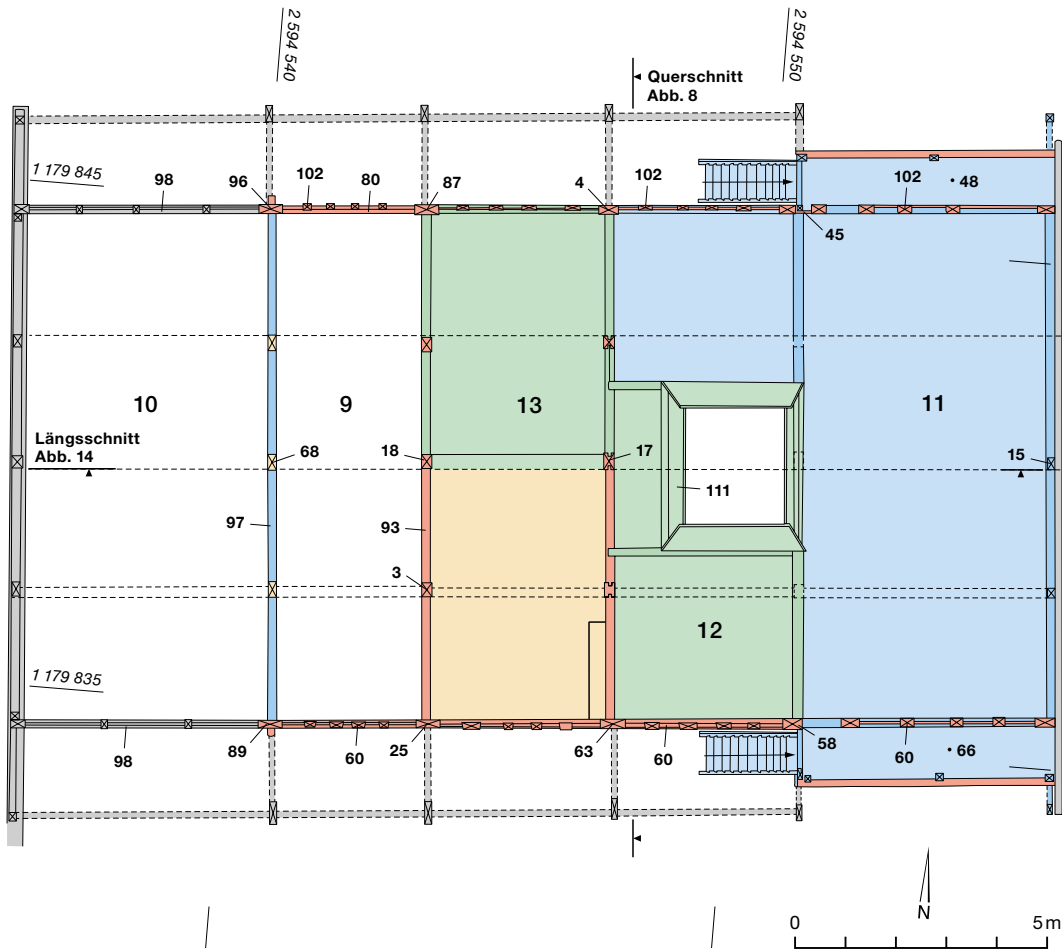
Rüschegg Sangern 183. Grundriss des Dachgeschosses. Die im 19. Jahrhundert durchgeführten Umbauten im Erdgeschoss schlugen sich über dem Wohntrakt in unterschiedlichen Fussbodenhöhen nieder. Im Unterschied zum prinzipiell offenen Tenn (Raum 9) verlor der Grossviehstall (Raum 10) erst Anfang der 2000er-Jahre seine Stalldecke. M. 1:150.
